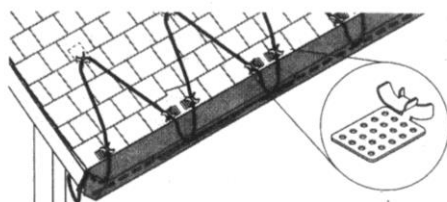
Пример расположения нагревательного кабеля на карнизном участке кровли с подвесным желобом
